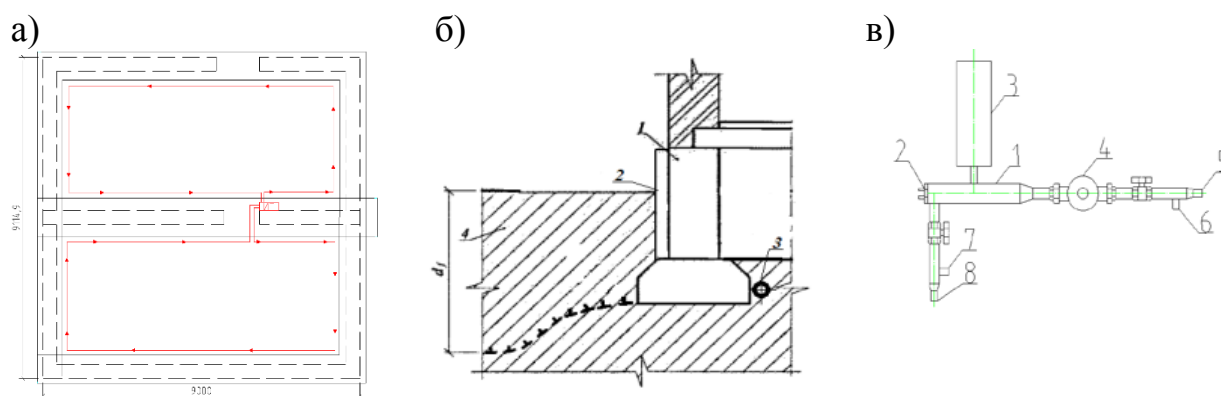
а – план прокладки греющих труб в грунте основания фундамента. ИТ – источник теплоты (создано авторами)
